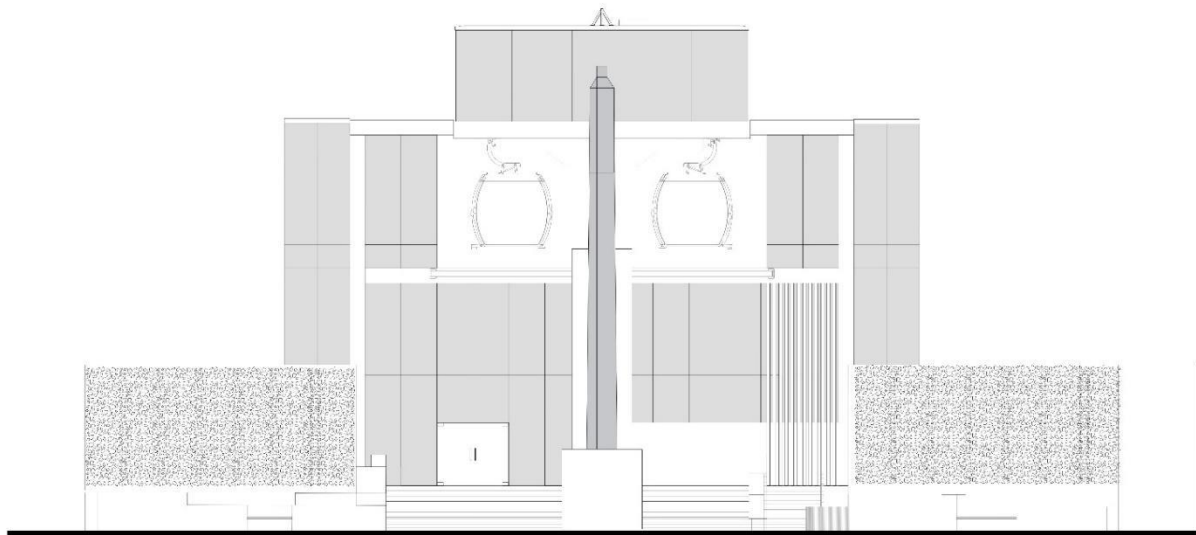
Fachada poniente de estación 6 Metro Constituyentes – Los Pinos
